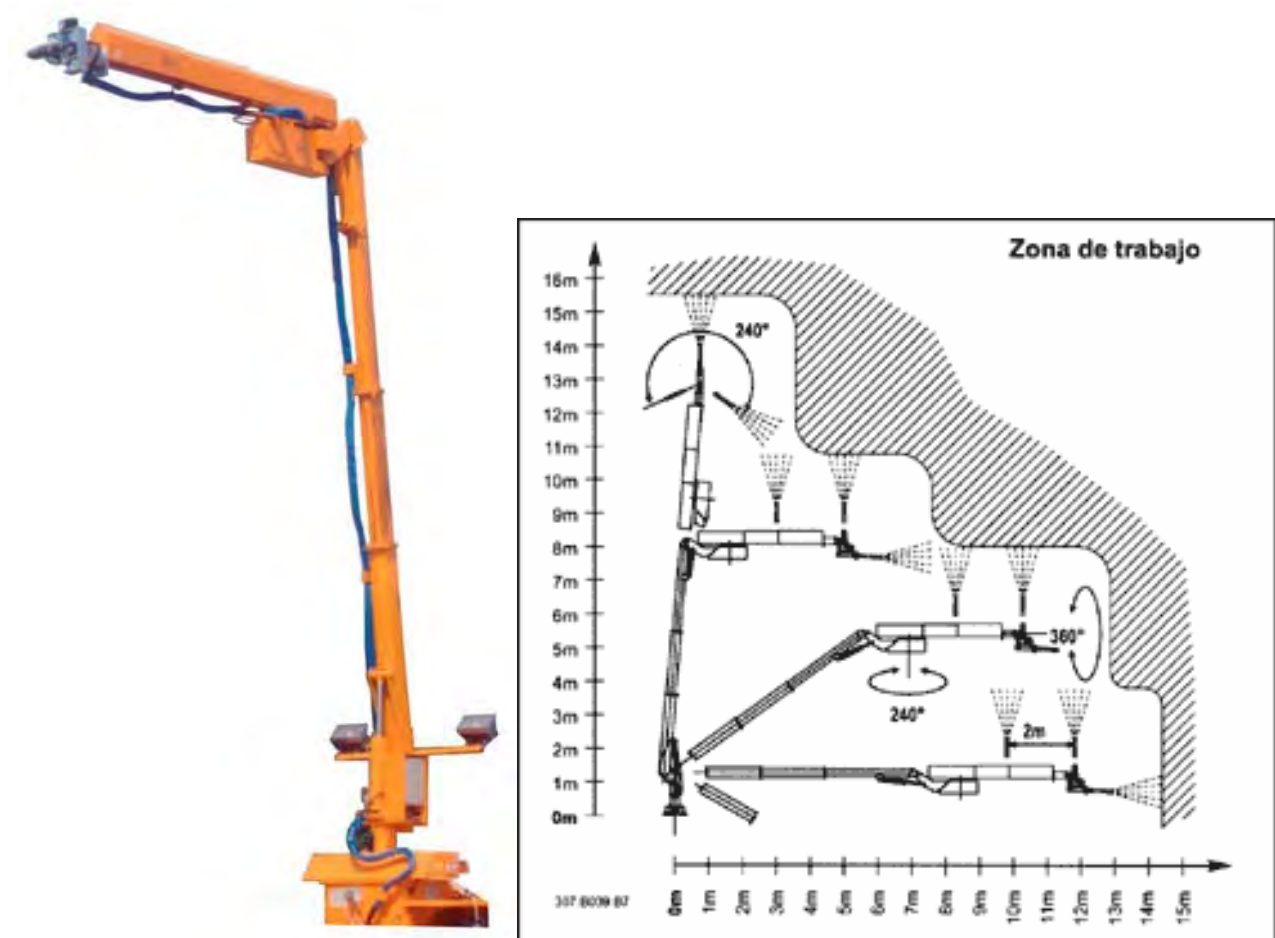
Brazo proyector telescópico de Concreto Lanzado y gráfica de su zona de trabajo.
